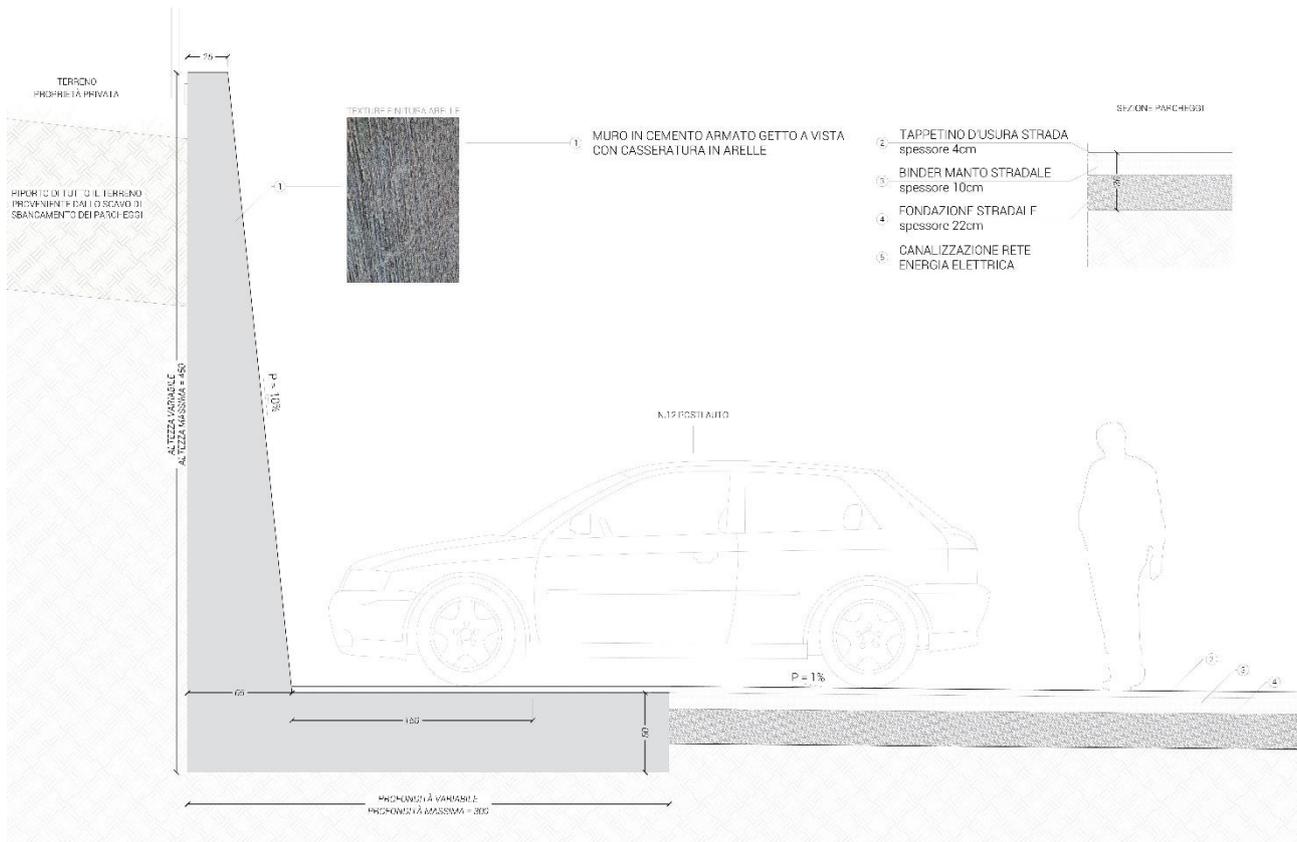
Estratto da All. EA_c_05_R2_Stato di progetto
